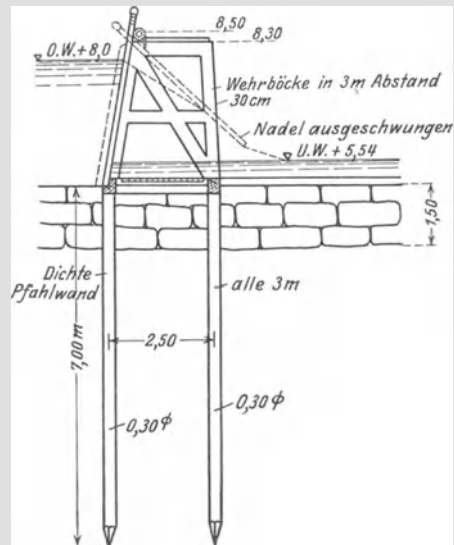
Nadelwehrbock auf Pfählen aus Eisenbeton. Maßstab 1: 150.
